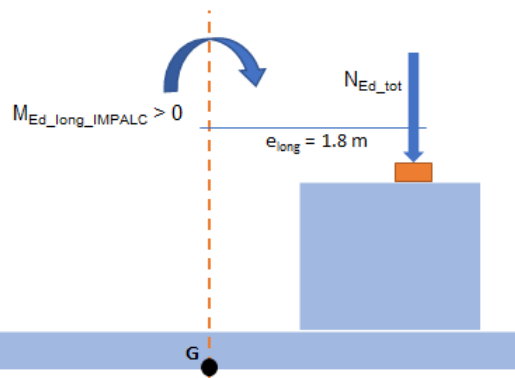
Sezione verticale, longitudinale, su baricentro plinto – schema qualitativo – disposizione assi appoggi da asse spalla/platea. Momento risultante longitudinale per eccentricità carichi su appoggi
